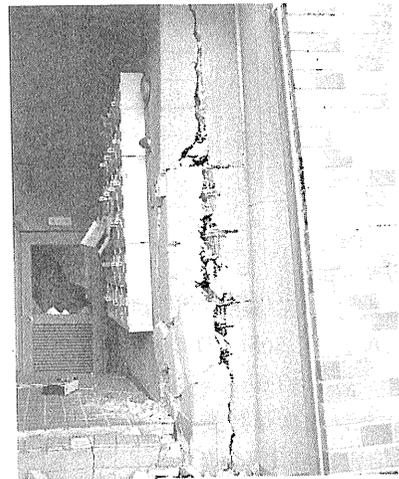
鉄筋コンクリート造高層集合住宅の1階柱の付着割裂破壊。
